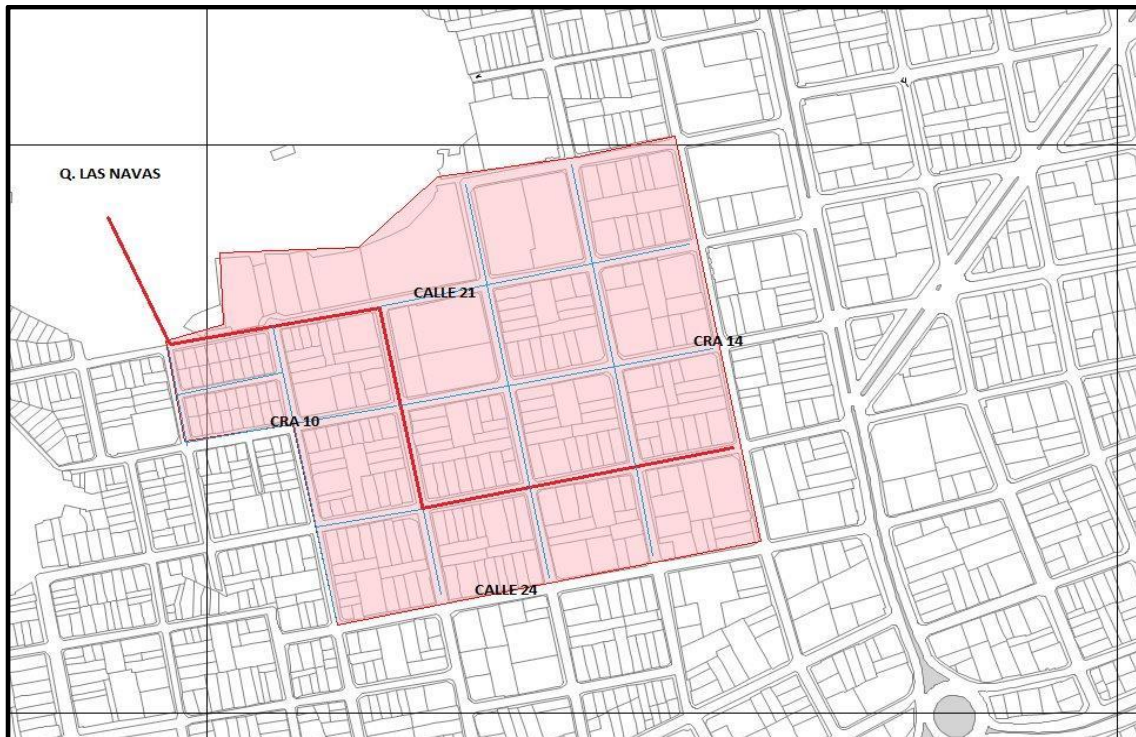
Redes Zona de Talleres de la Avenida Quebrada Seca con Carrera 15.
